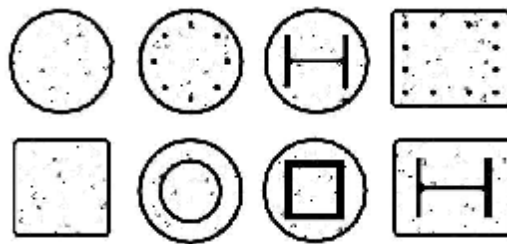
différentes sections de poteaux creux remplis de béton
